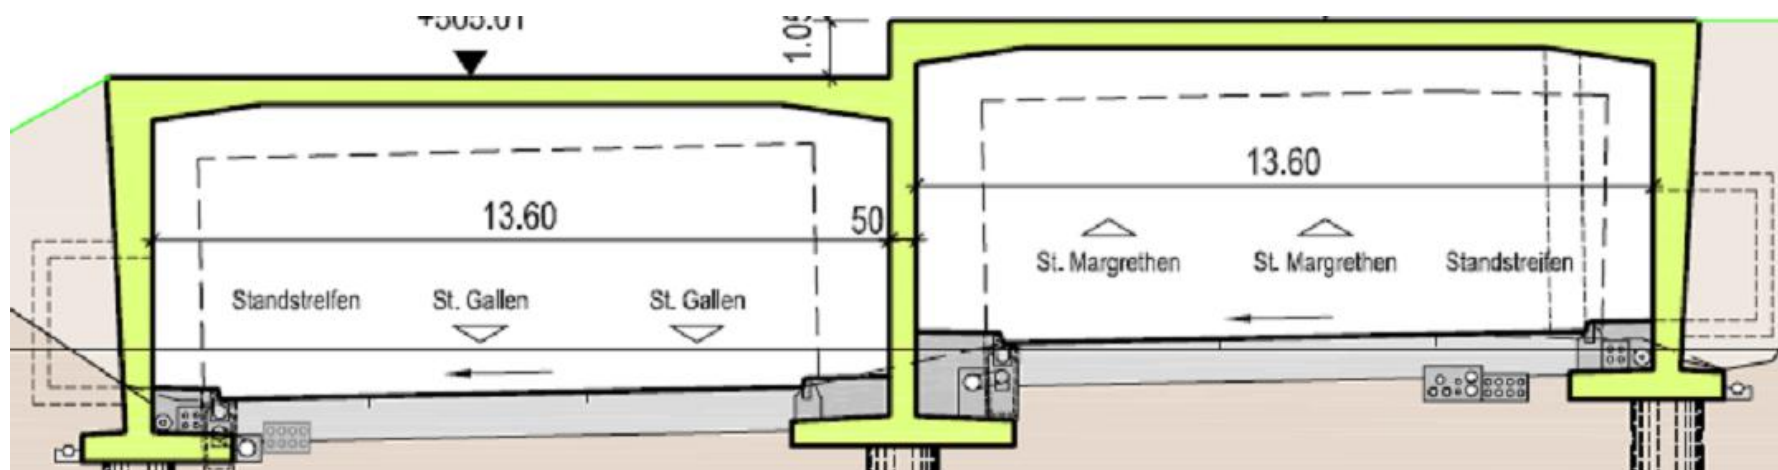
Profilo tipo dell'oggetto "galleria artificiale".
